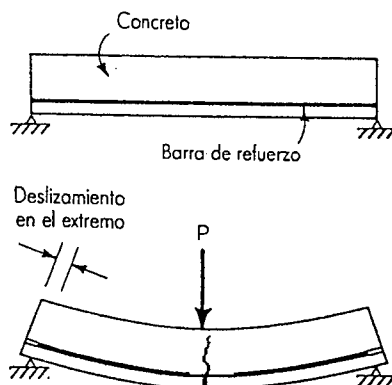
Viga sin adherencia entre el acero y el concreto.
